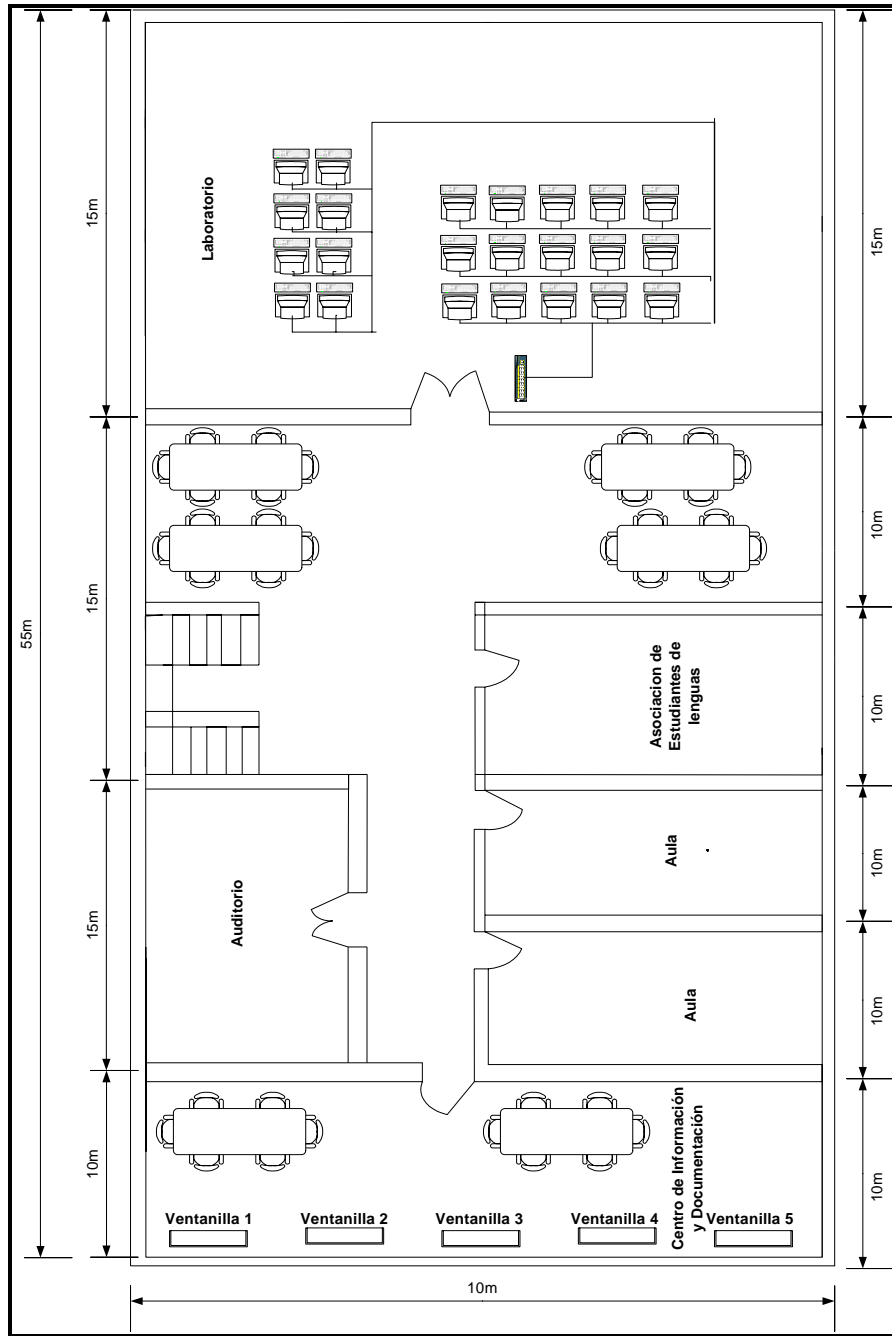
Plano Digital Primer Piso - Edificio Lenguas
